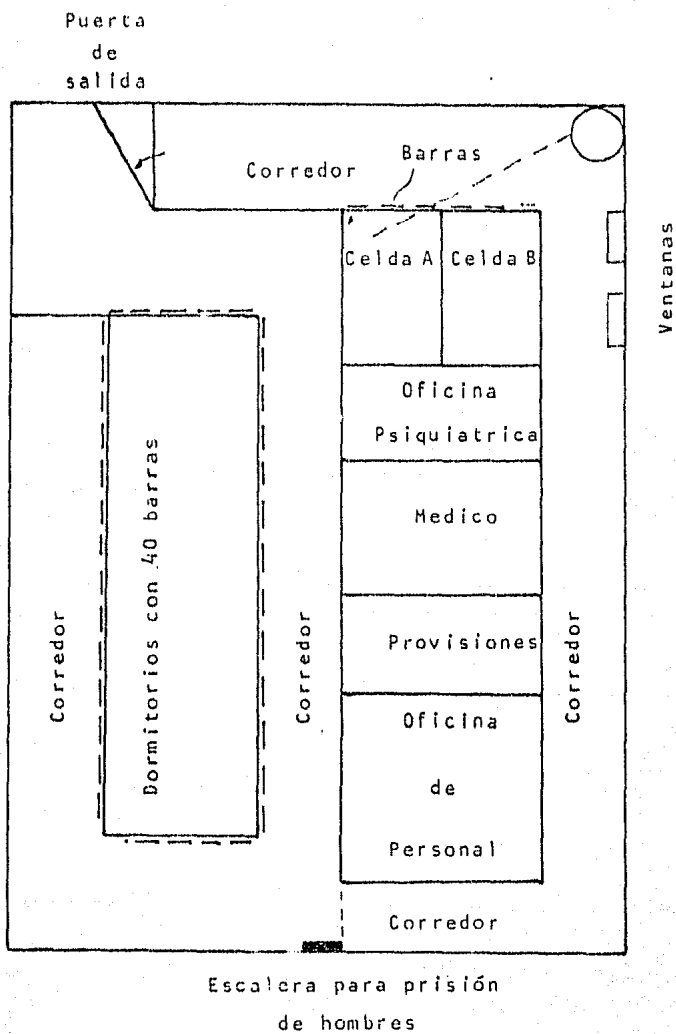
PLANTA DE LA CARCEL (SECCION DE MUJERES)
